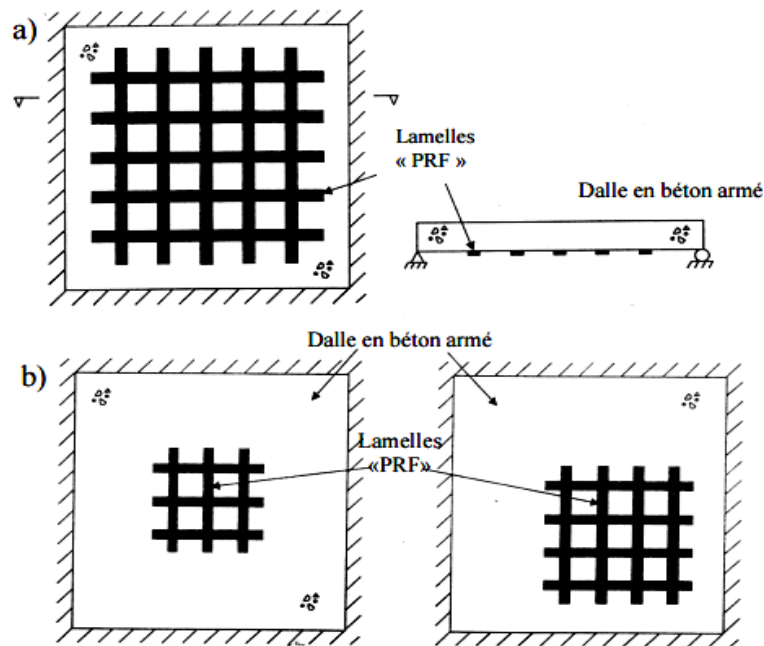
Renforcement d'une dalle travaillant dans les deux sens par des lamelles en «PRF»:
